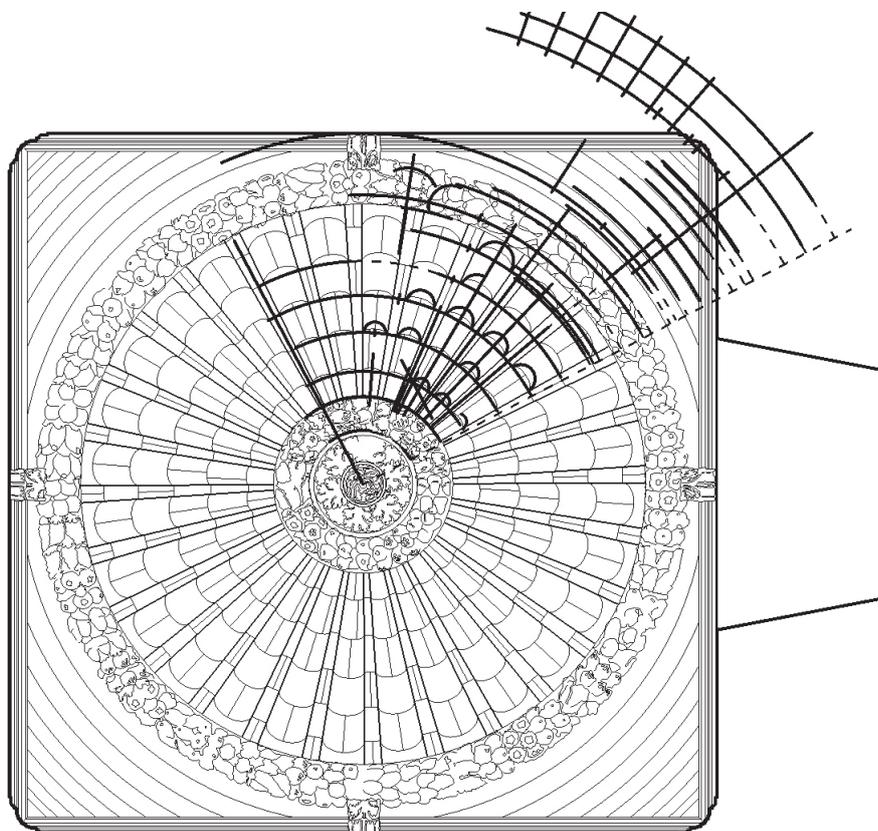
Montea de la bóveda de la sacristía de la catedral de Murcia, superpuesta a la planta de la bóveda. J. Torni, 1525. Levantamiento de M. Alonso.
